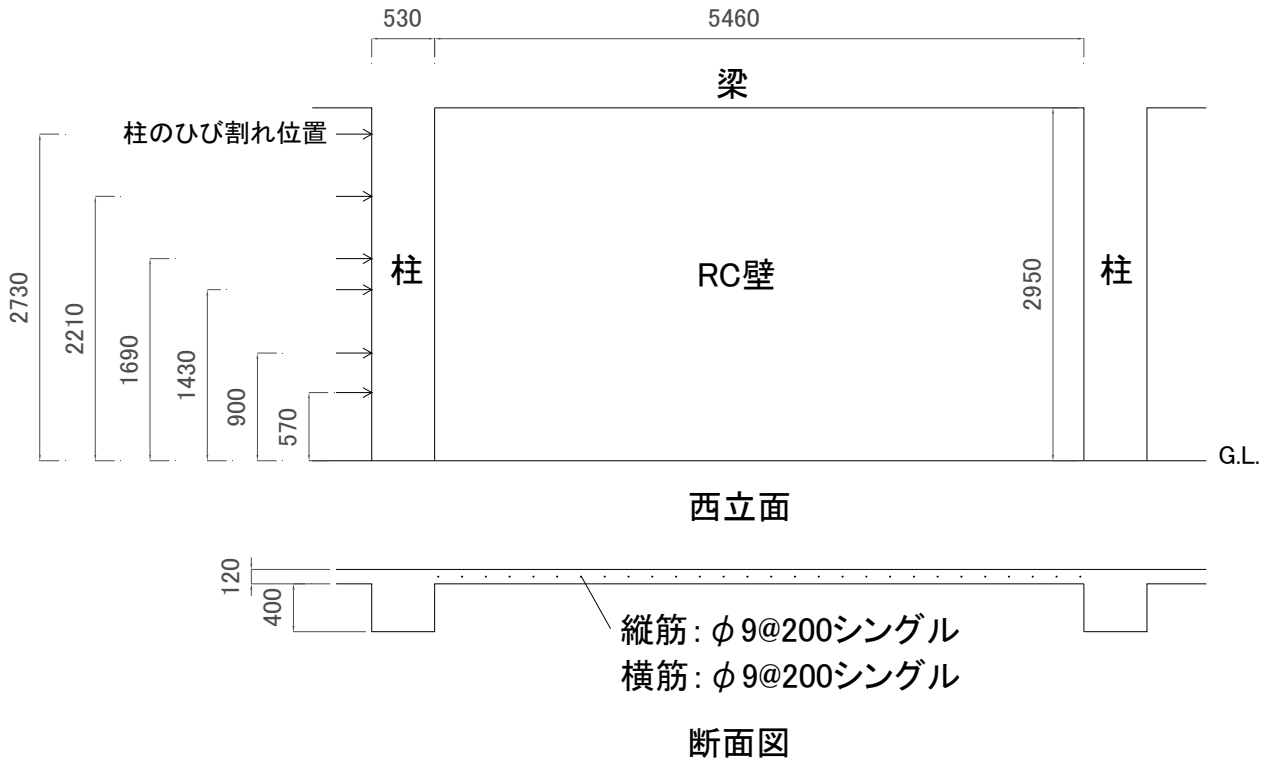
ひび割れが生じた RC 壁の立面図・断面図 (単位 : mm)
